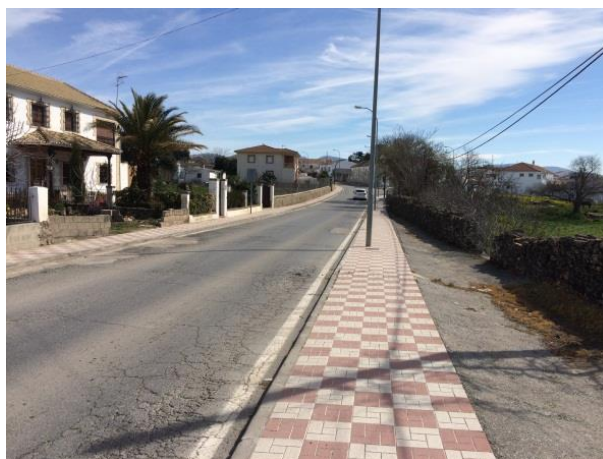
Sección tras intersección con calle humilladero, se aprecia un deterioro del firme
